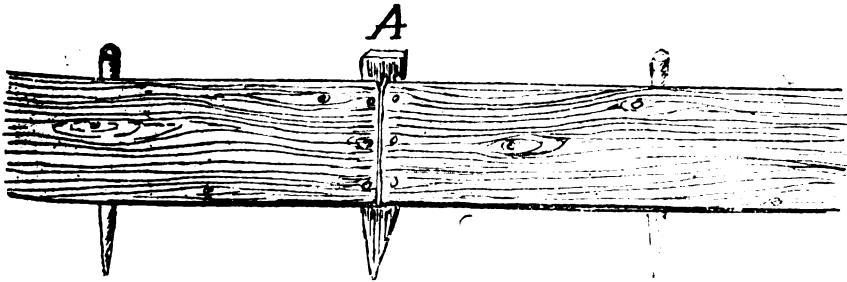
Juxtaposition de deux planches sur un piquet plus large : au milieu de chaque planche, un piquet ordinaire
